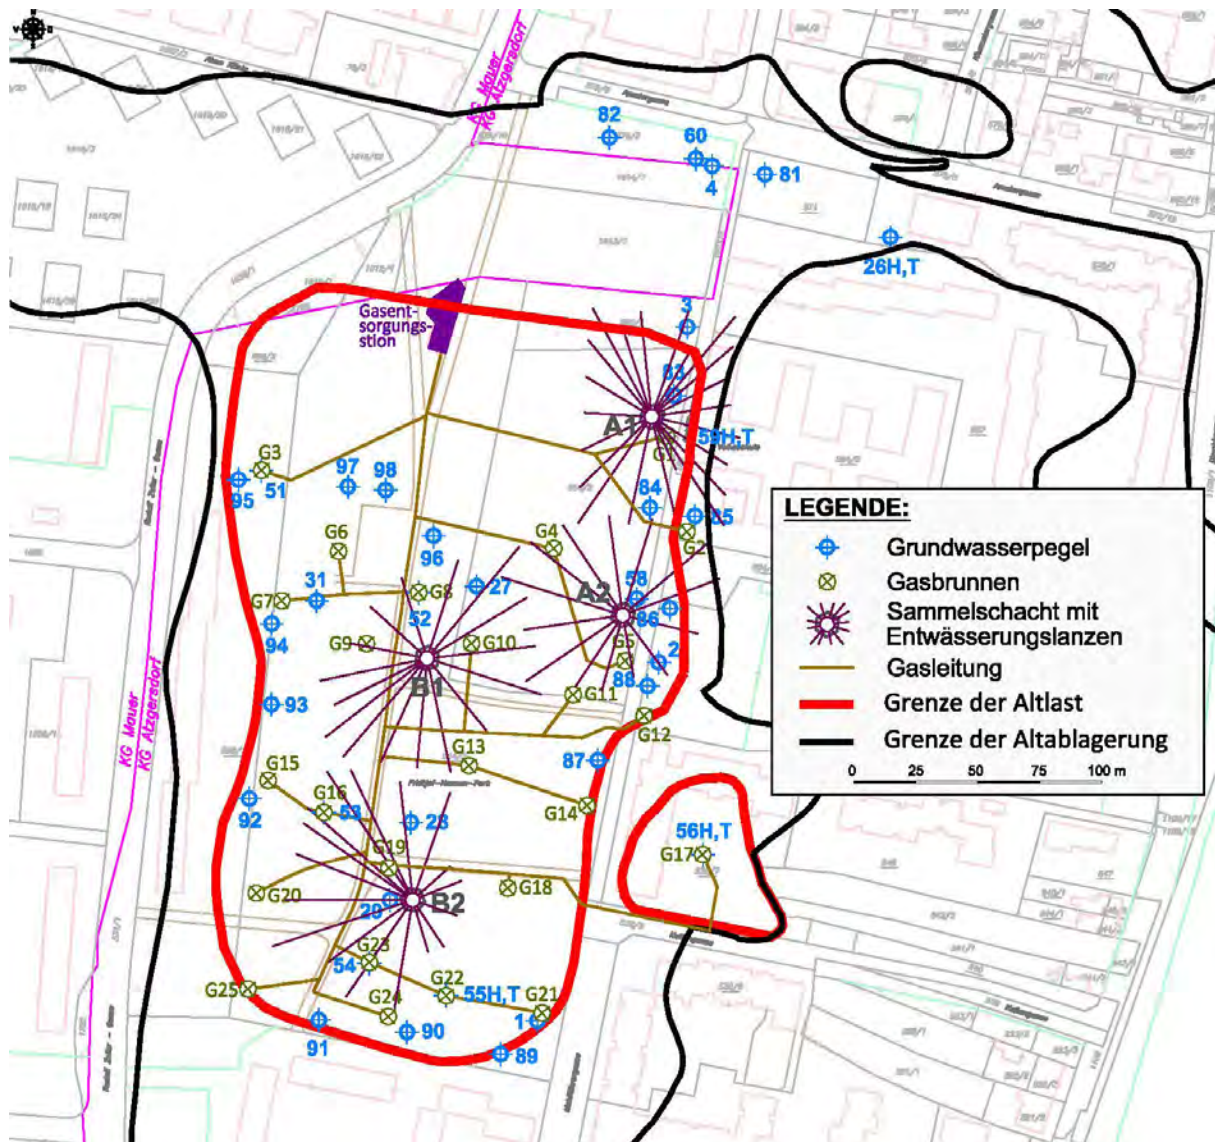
Situationsplan mit allen Sicherungsbauwerken
